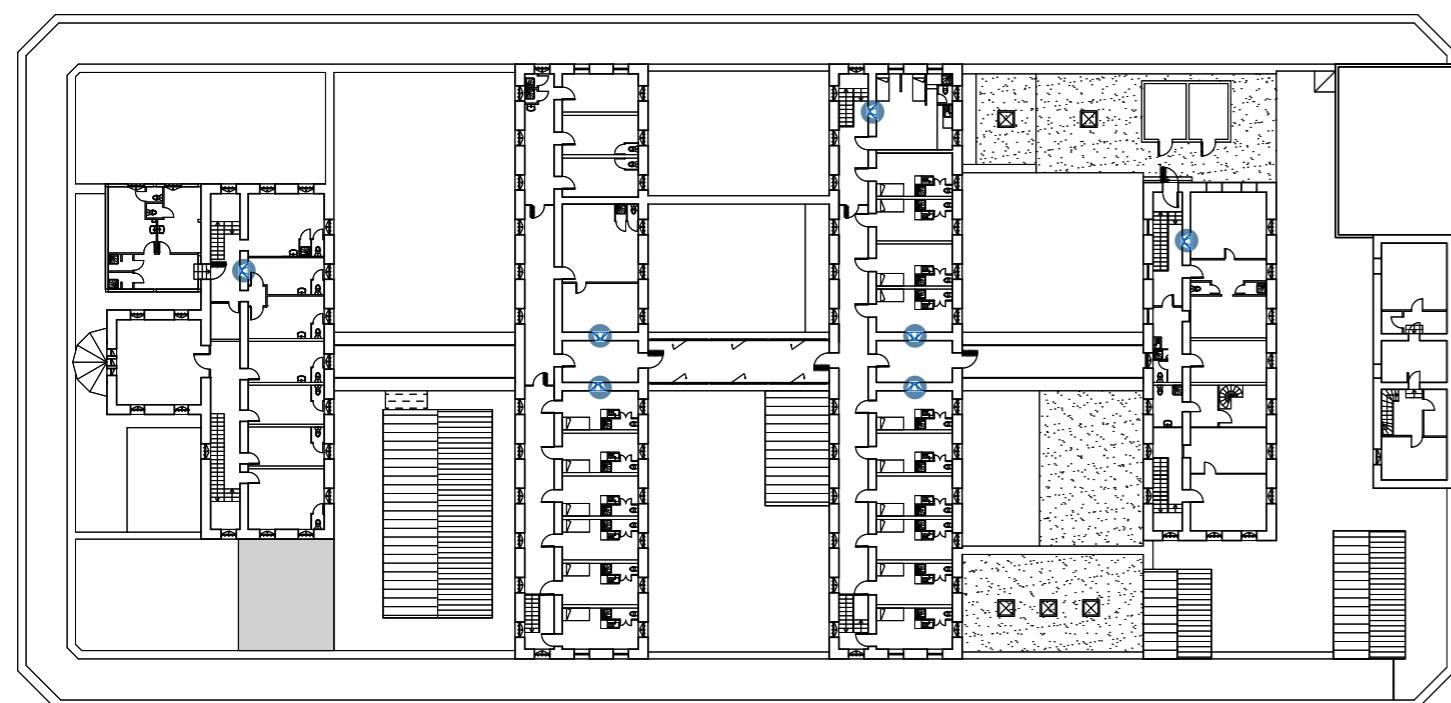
Plan de R+1 : repérage des judas. Source : Croisée d'archi.
